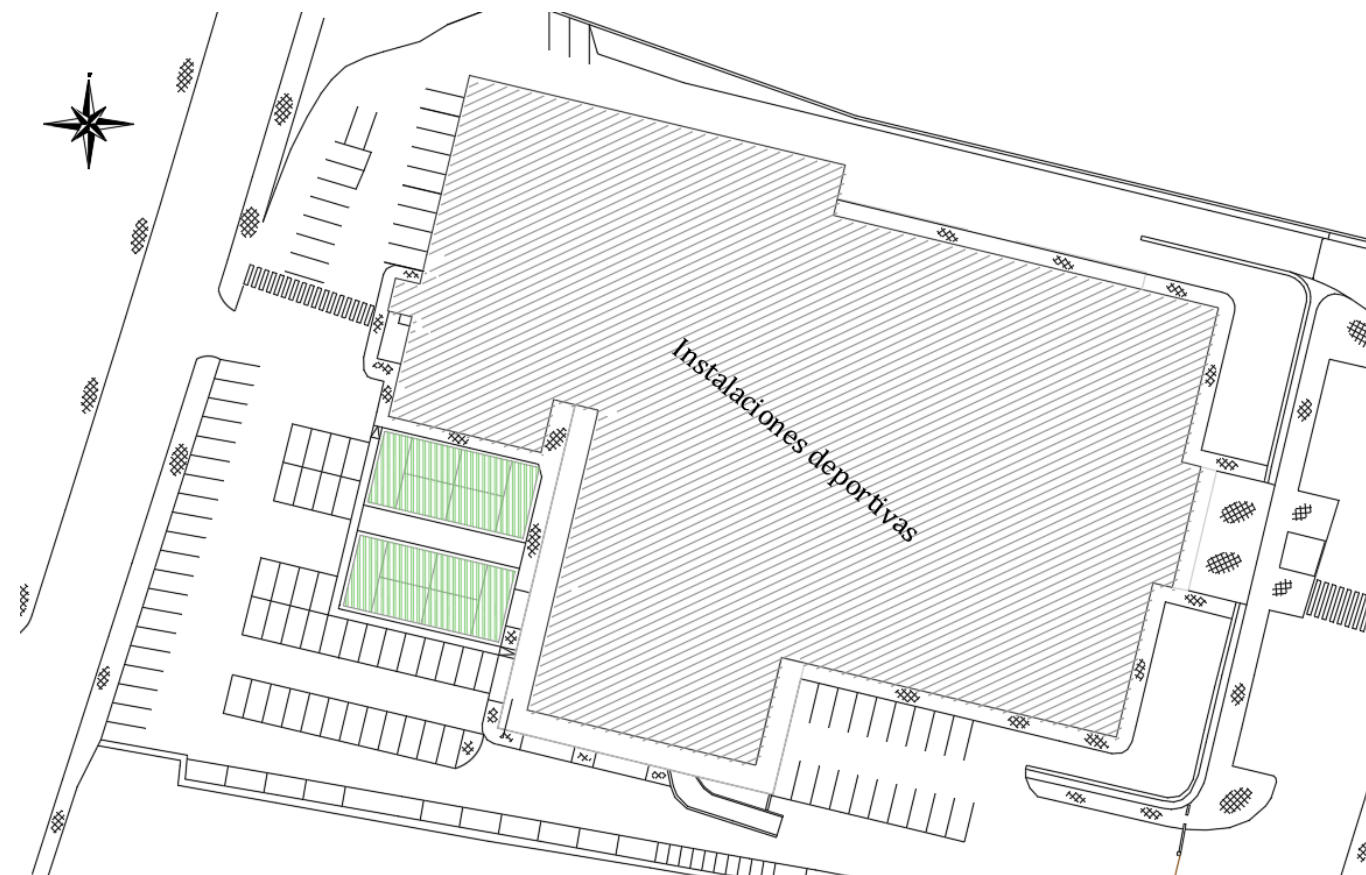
Alternativa 1 para la orientación de las pistas de pádel.
